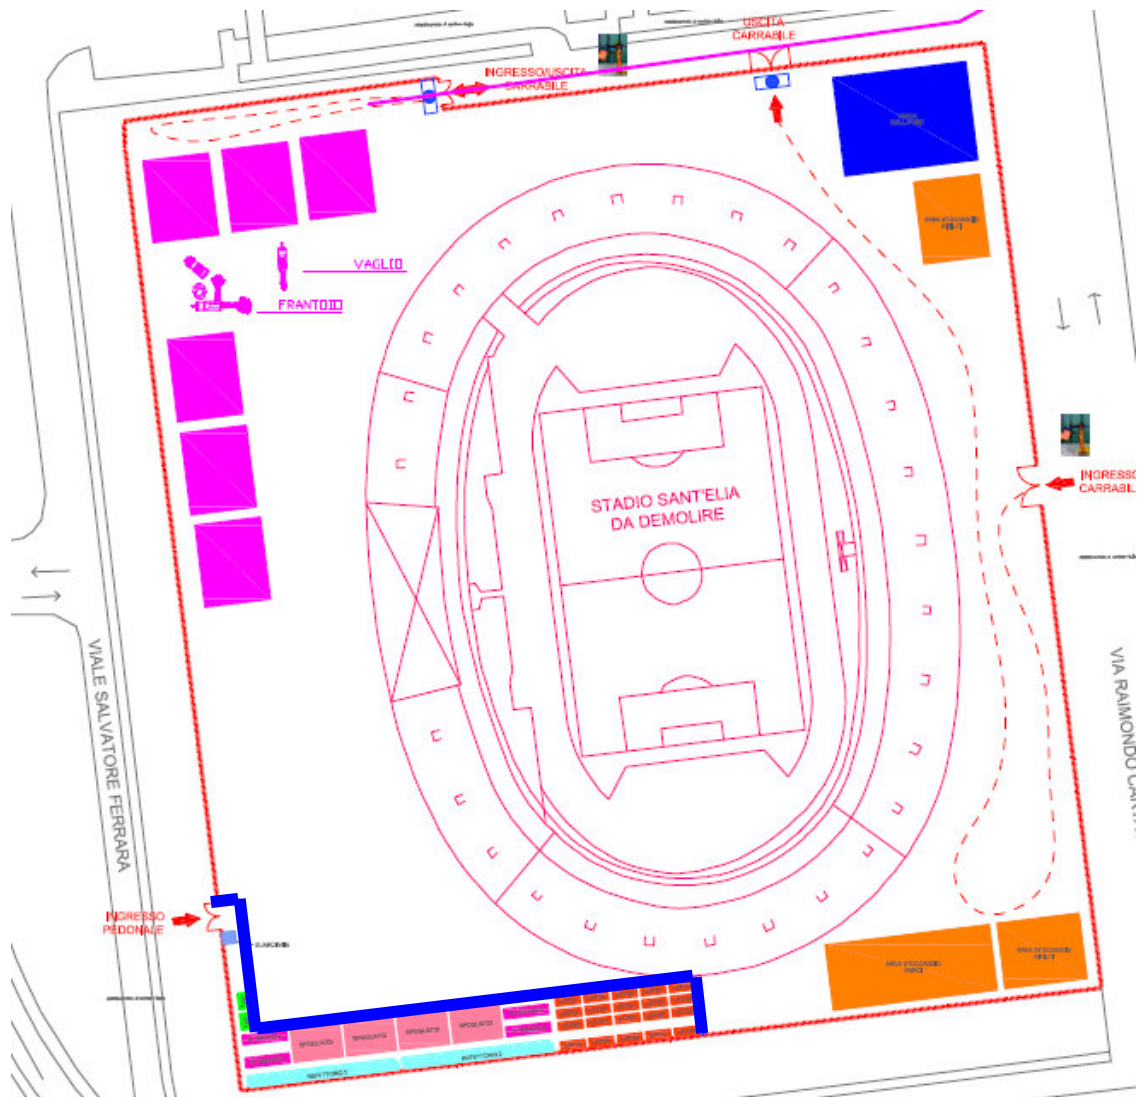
fase di demolizione con indicato lo sviluppo in pianta della recinzione fonoassorbente (linea blu)
